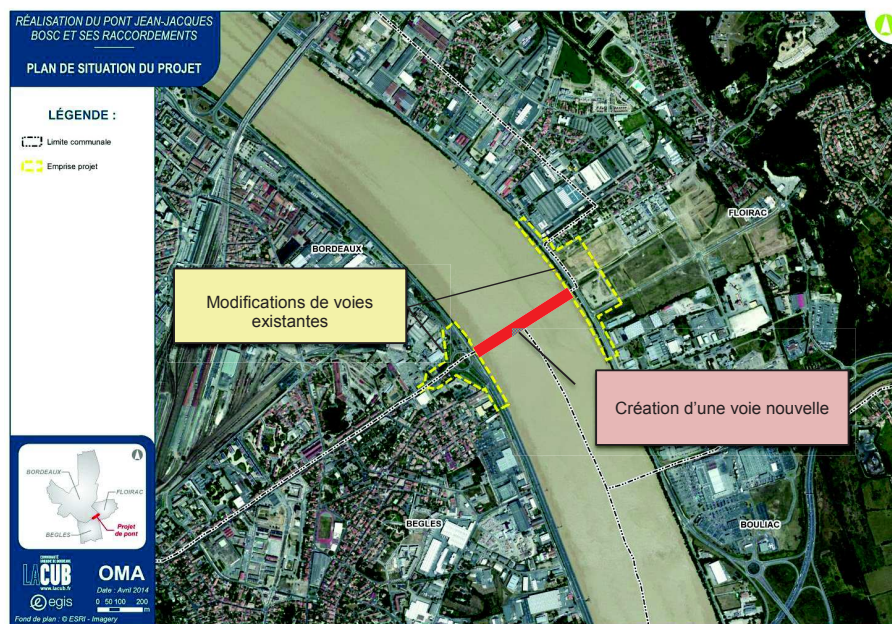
Plan de situation du projet du pont Jean-Jacques Bosc et ses raccordements
